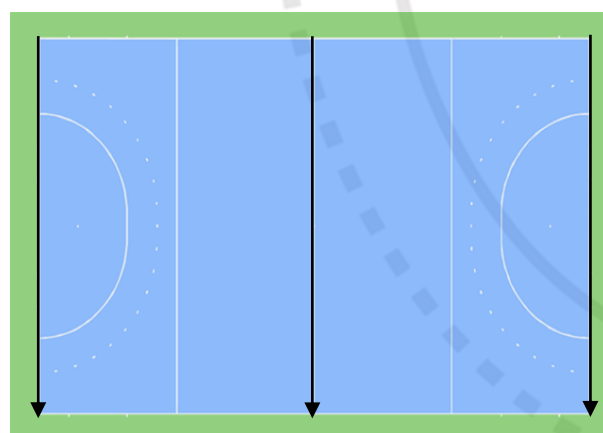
Plano único con pendiente transversal, más comúnmente utilizado con construcciones de drenaje vertical
